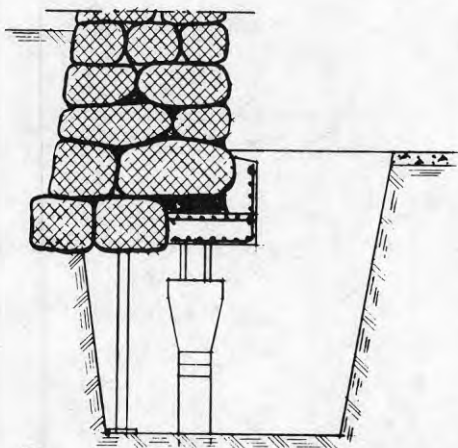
Grundförstärkning, undergjutning till fastare jordlager.
